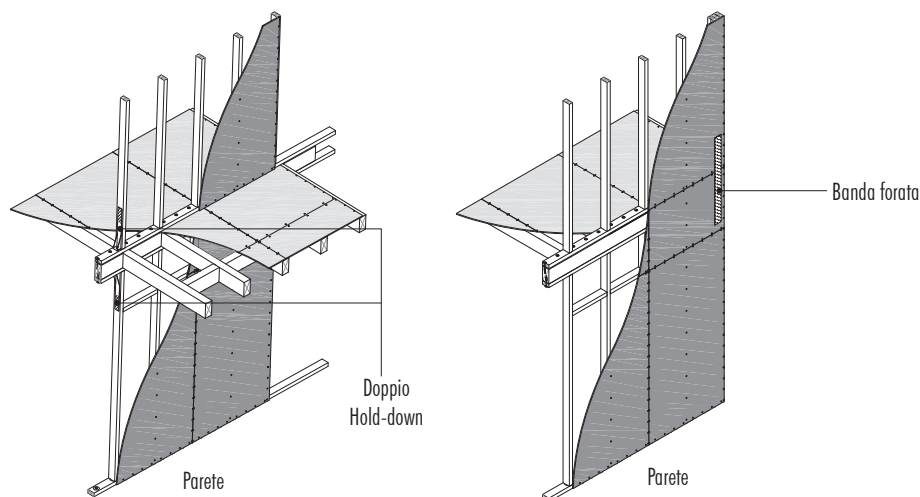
Collegamenti di interpiano pareti esterne e interne.
